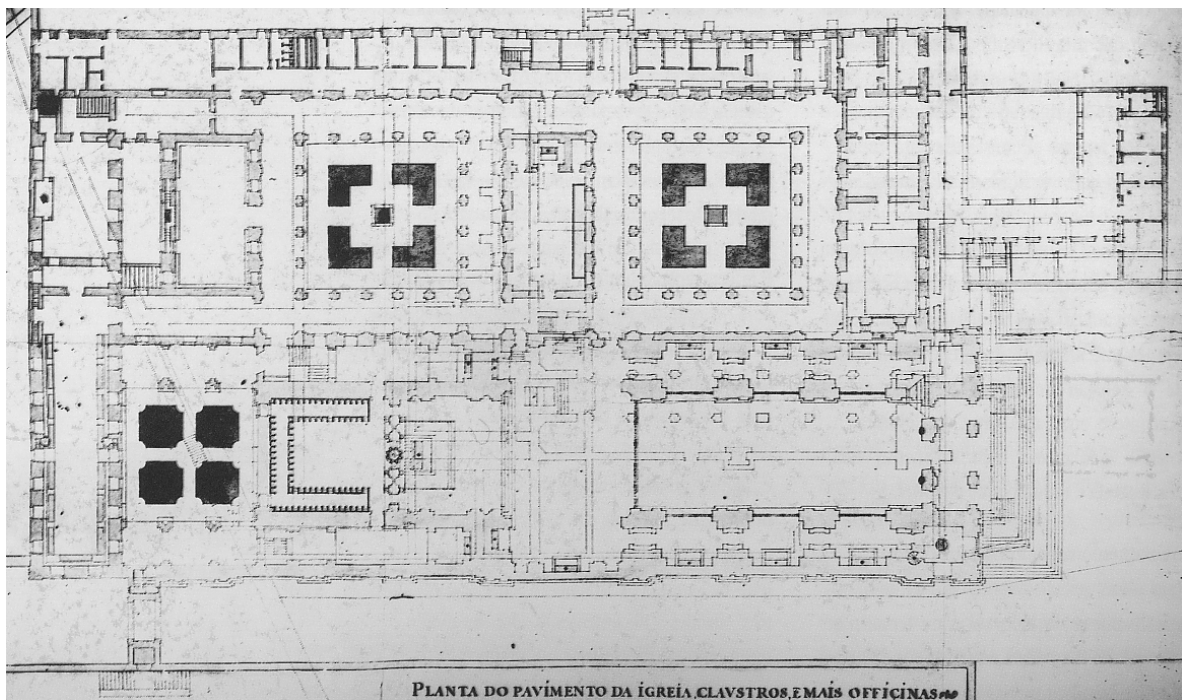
Planta do mosteiro de São Vicente de Fora (Arquivo DGEMN).
